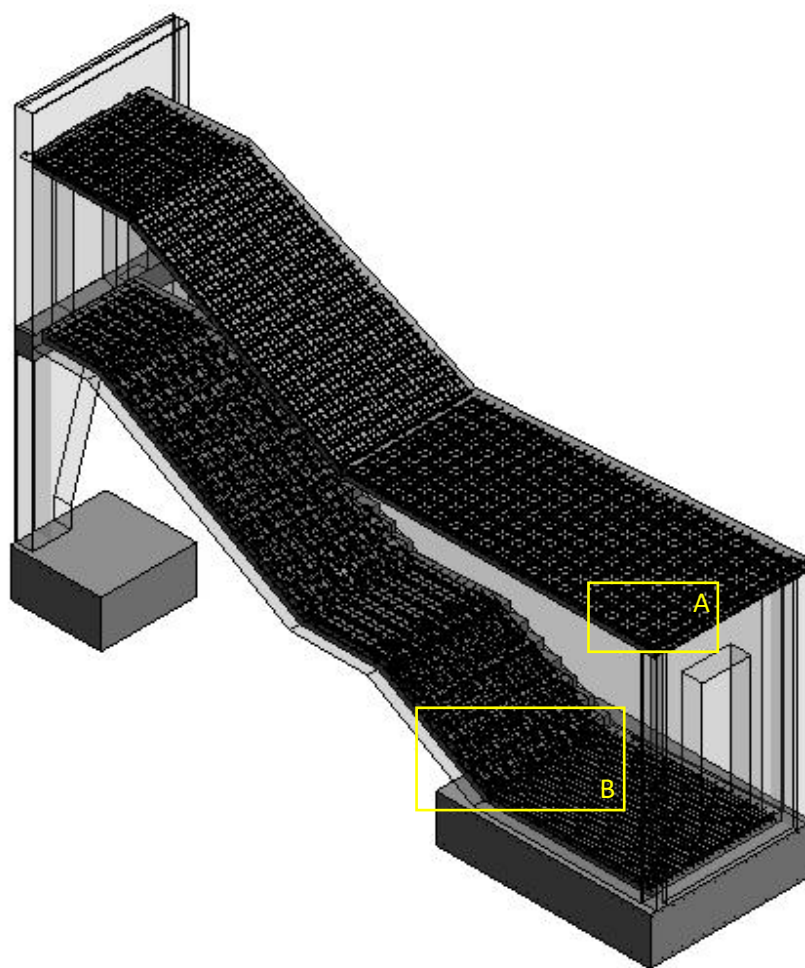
Modelos 3D de armaduras – Lajes do acesso exterior do centro de conferências
